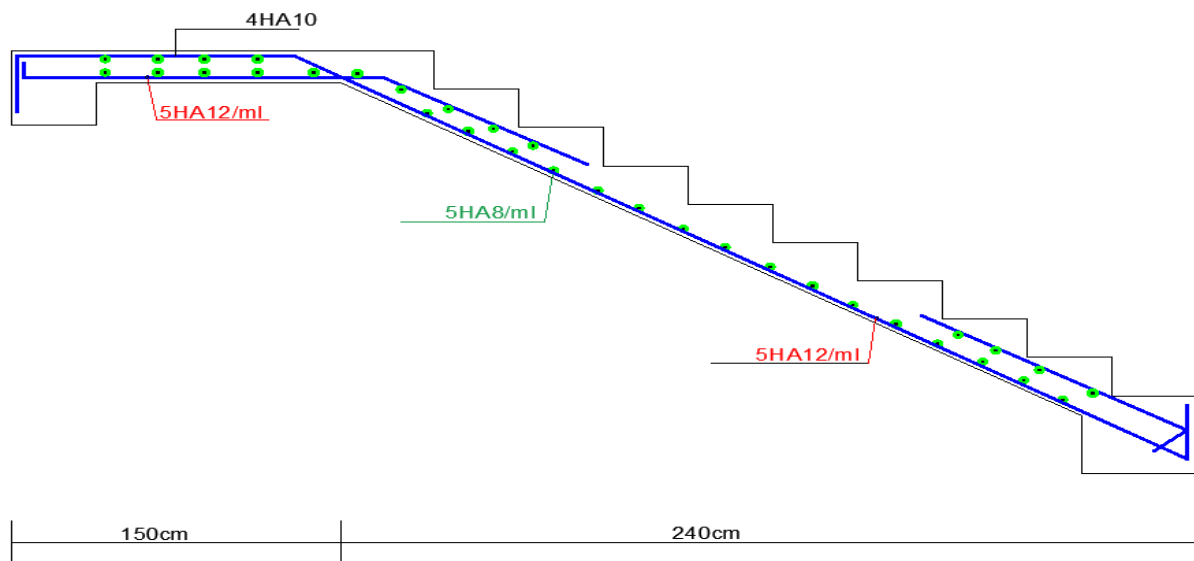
Ferrailage des escaliers selon l'EC2.
